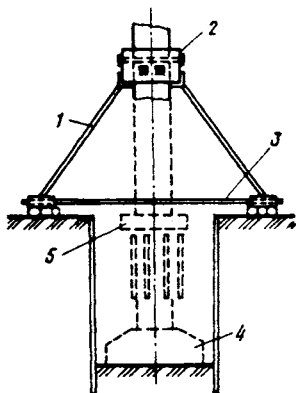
Подводка фундаментов под колонны на глубоких отметках с помощью приспособления «ножницы»:
